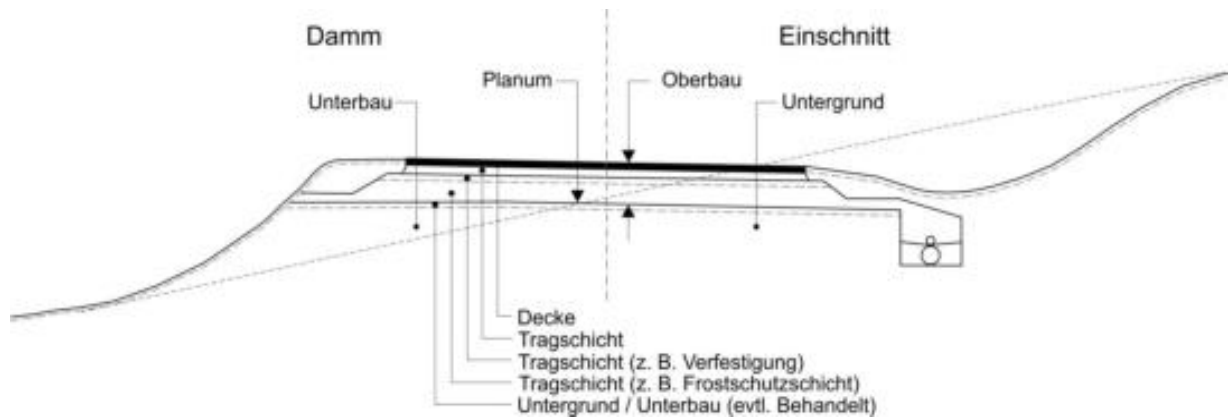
Beispielhafter Aufbau einer Befestigung außerhalb geschlossener Ortslage sowie in geschlossener Ortslage mit wasserdurchlässigen Randbereichen – Damm/Einschnitt –
